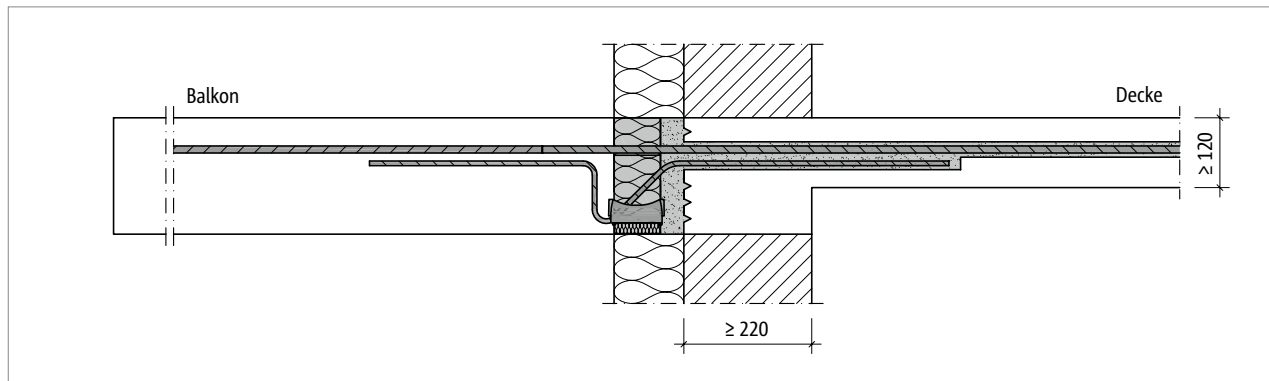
Schöck Isokorb® RT Typ K: Anschluss bei Wärmedämmverbundsystem (WDVS) und dünner Decke
